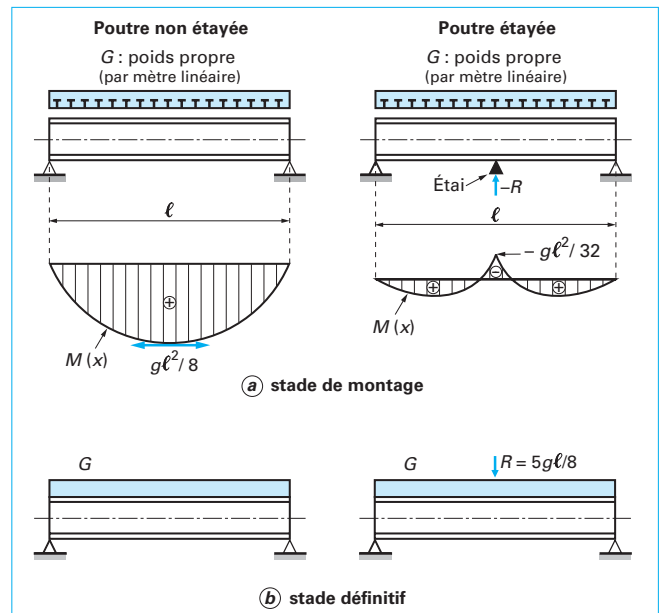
Mise en évidence d'une réaction d'étai au stade définitif de la construction
